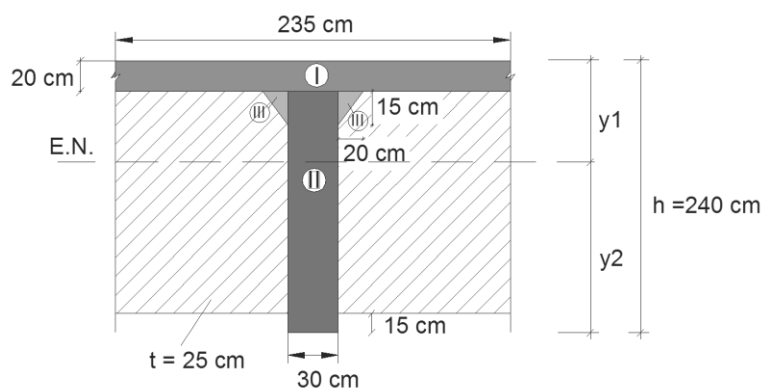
30 Propiedades de la Sección transversal de la viga en el centro de la luz
